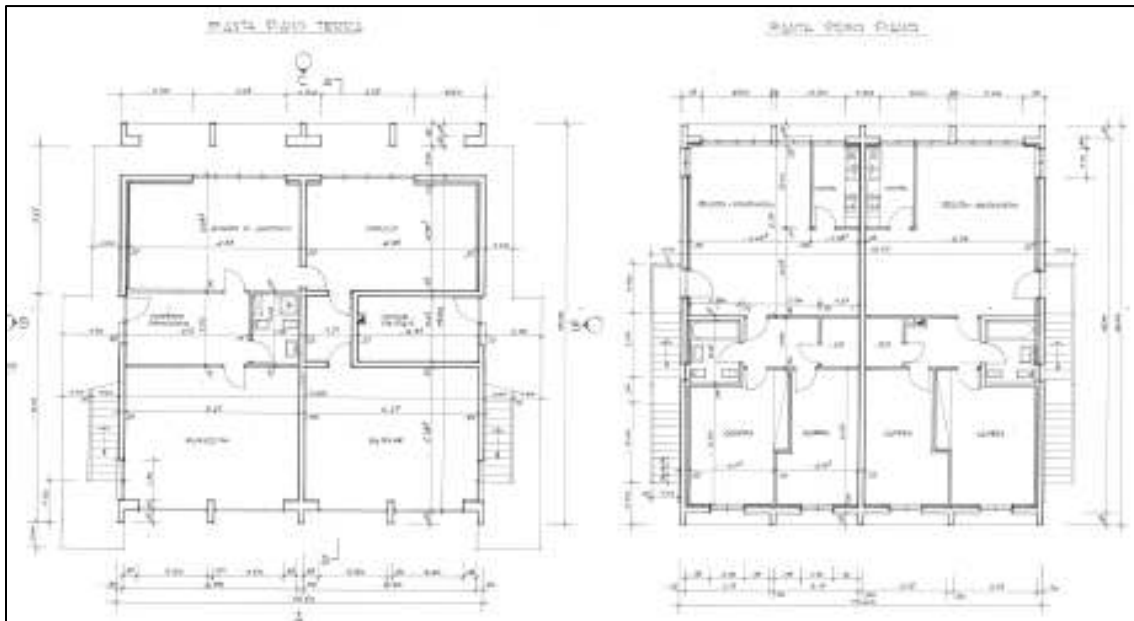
Casa di guardia – Pianta piano terra e primo piano (progetto esecutivo 1985)
